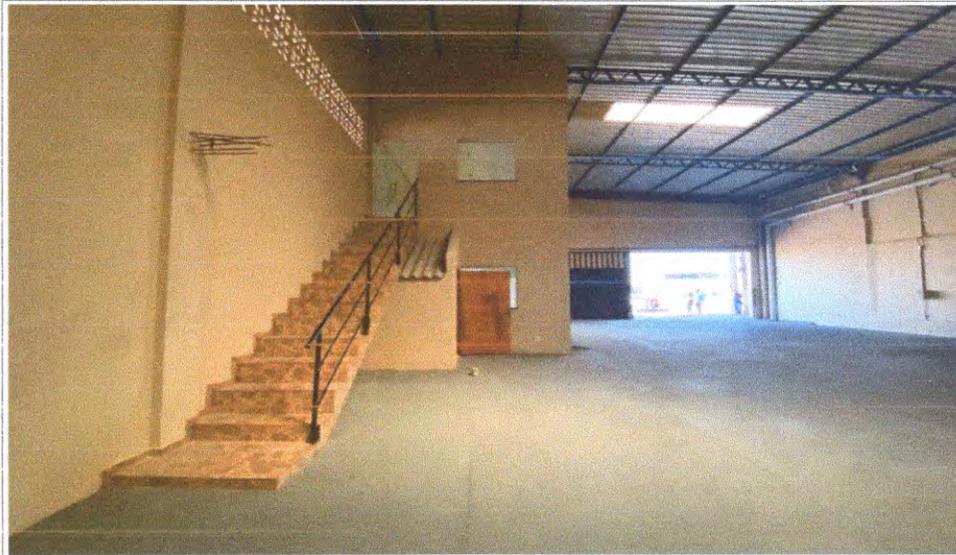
Escada que possibilita o acesso do pavimento térreo ao pavimento superior do bloco 01.
